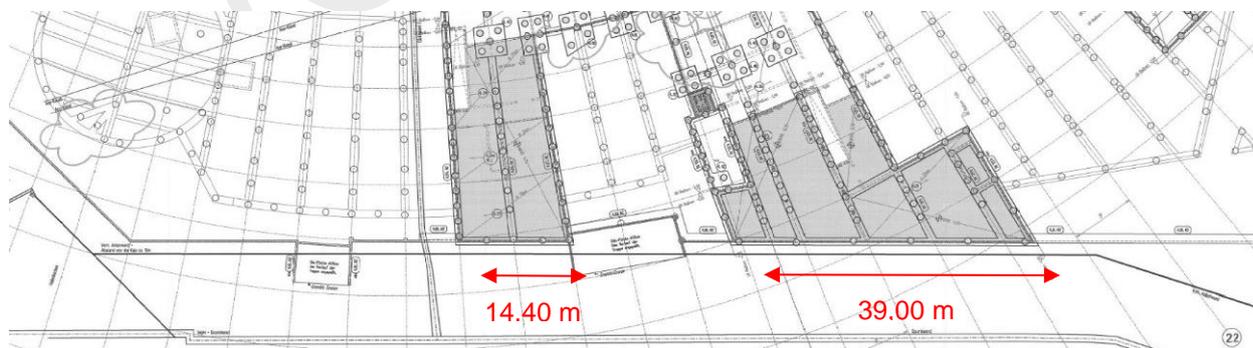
Unterkellerte Bereiche – Ausschnitt aus dem Plan BSP02-01 i (Stand: 16.11.2001)
